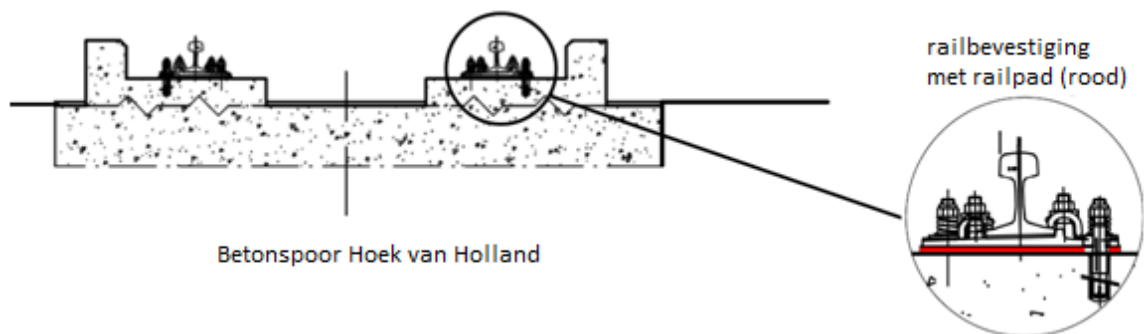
Betonspoor tussen eindstation en Strandweg.
